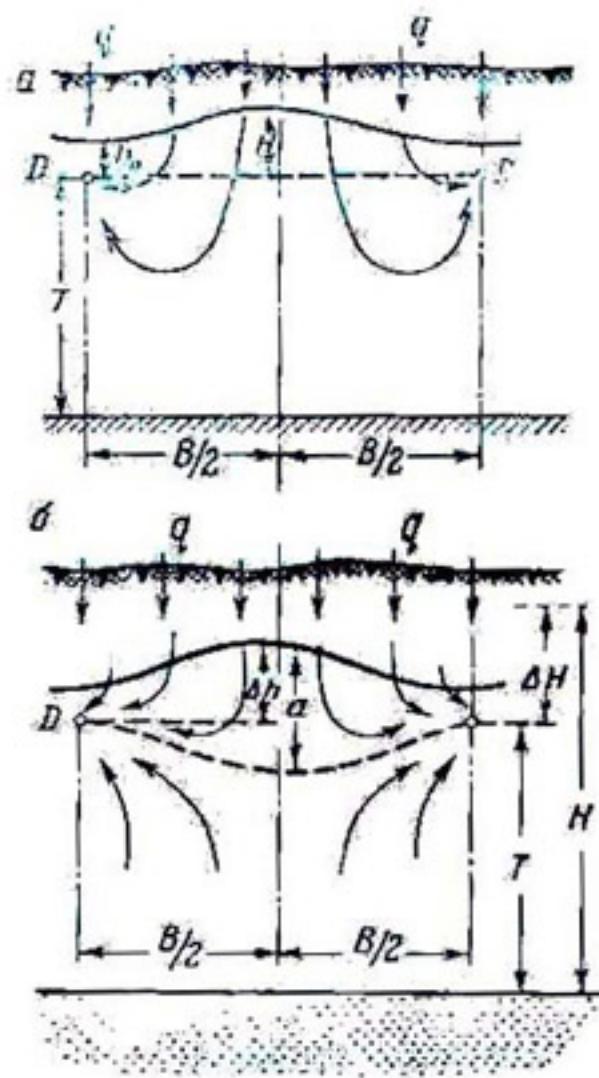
Схемы отвода грунтовых вод горизонтальным дренажем:
